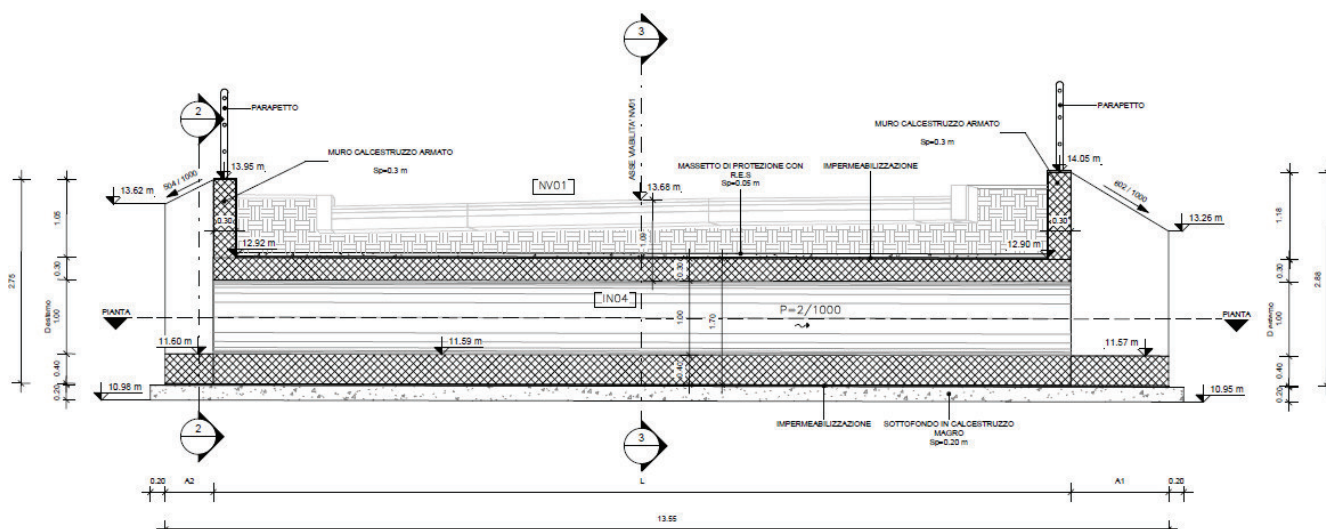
IN04-IN16 tombino stradale circolare – sezione longitudinale
